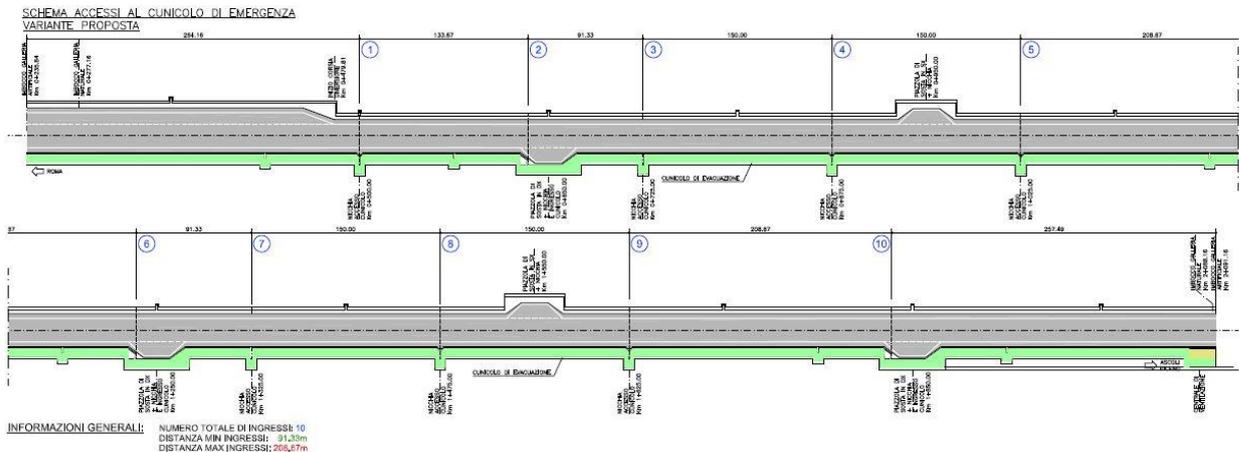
Schema planimetrico con cunicolo di evacuazione (in verde)
